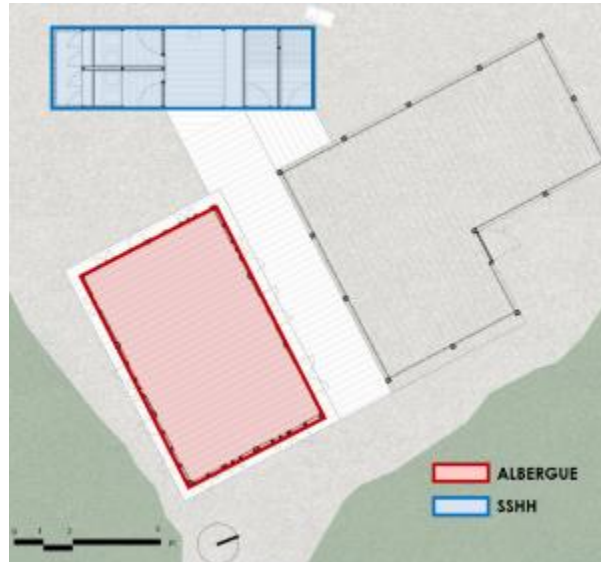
Planta arquitectónica de Albergue. Fuente: Archivo Construye Identidad.
